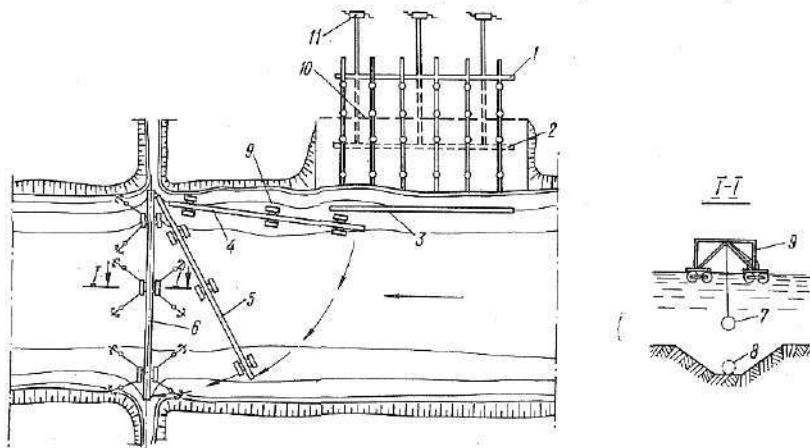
Схема укладки трубопровода с плавучих опорных точек:
